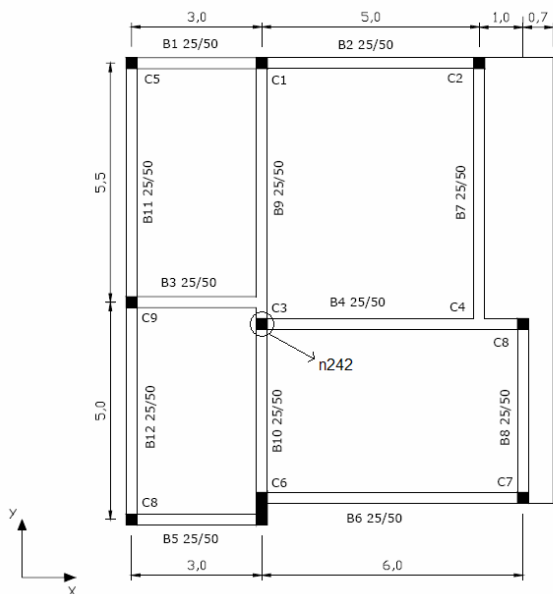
Planta da estrutura [m] e localização do nó n242.
